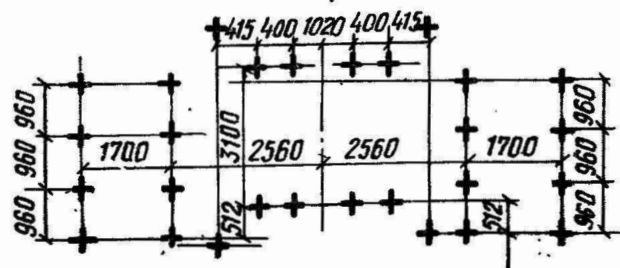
Схемы расположения фундаментных болтов для крепления вентиляторных агрегатов Кт-160, 200, 250
